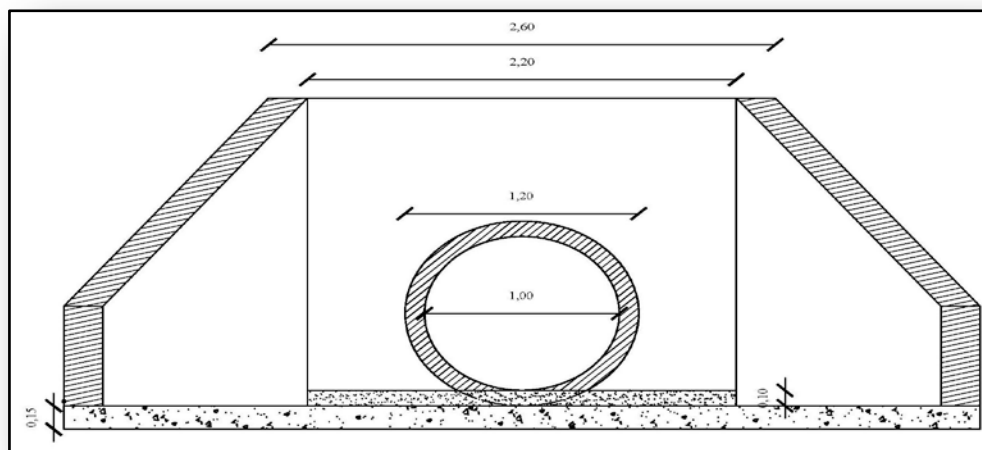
Coupe transversale de l'ouvrage.
